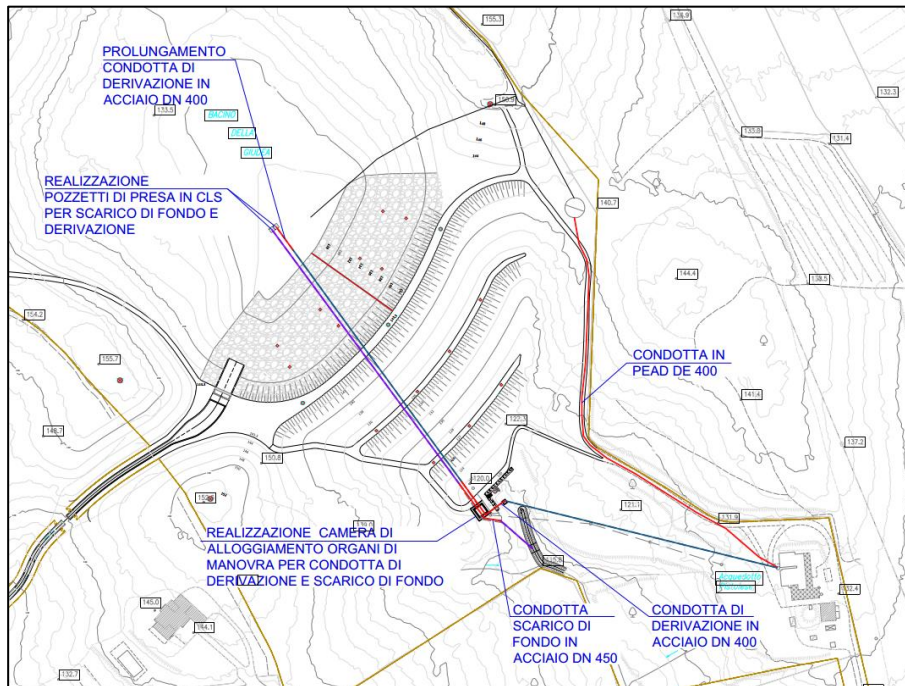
Planimetria condotte di derivazione e scarico di fondo allo stato di progetto
